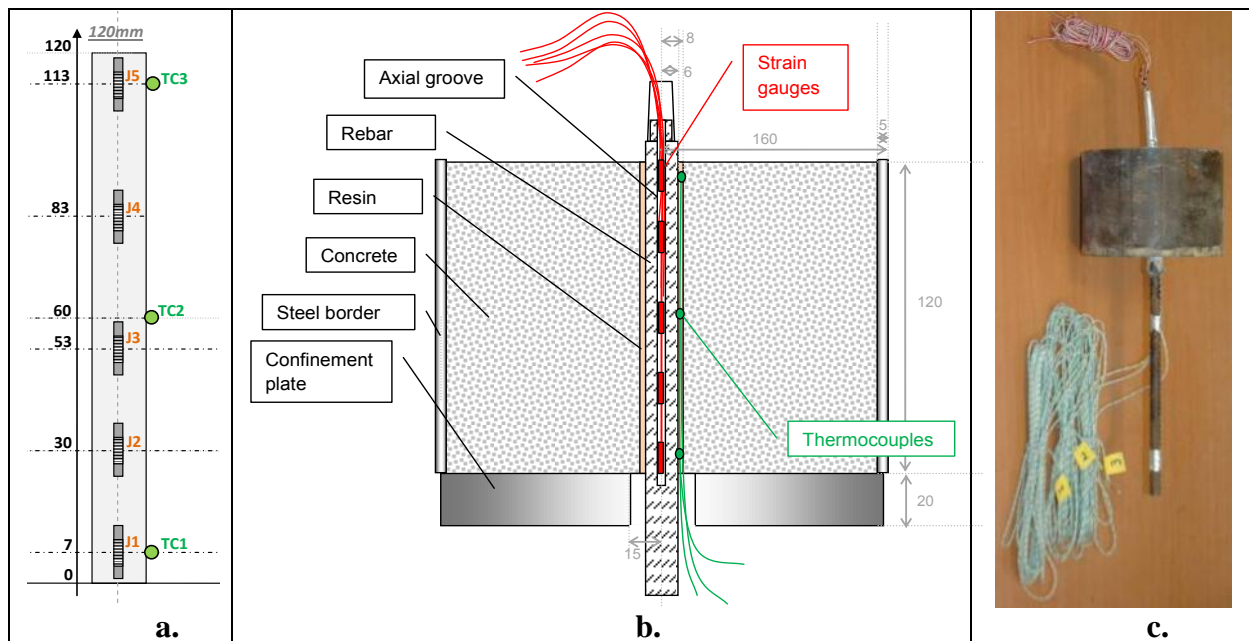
a) Position des jauges b) Géométrie de l'éprouvette c) Photo de l'éprouvette
